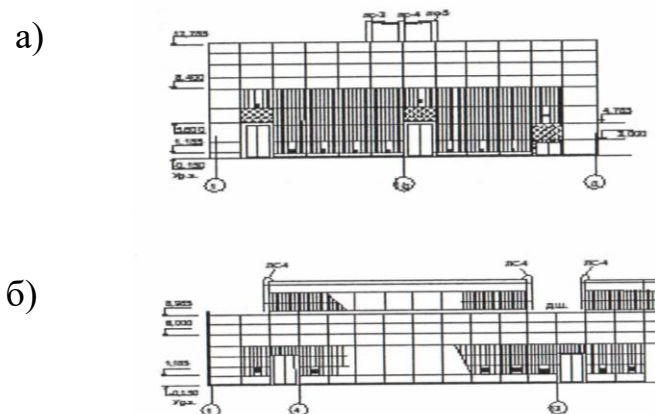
Примеры графического оформления фасадов одноэтажного промышленного здания: а – поперечного; б - продольного
